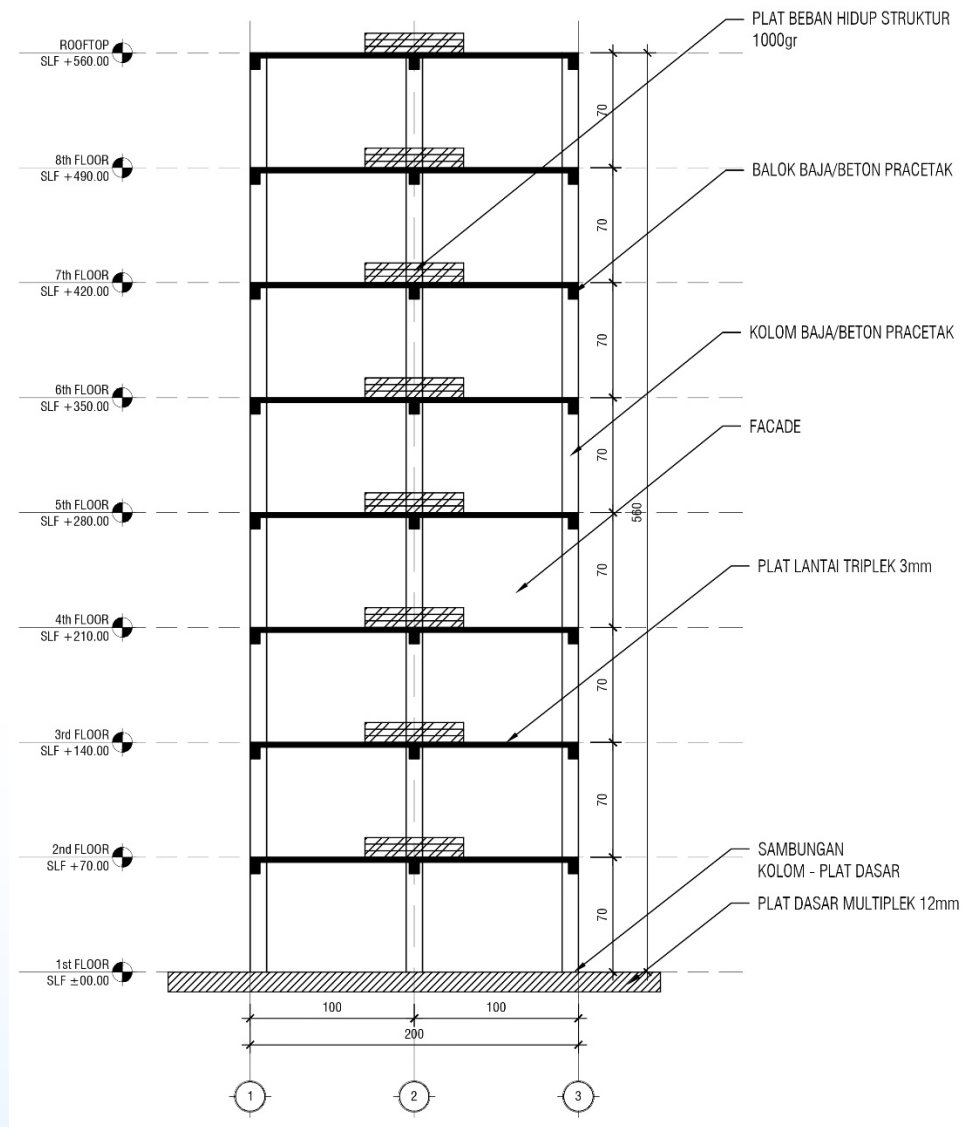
Perspektif Model Bangunan Gedung 8 lantai dari Baja atau Beton Pracetak
